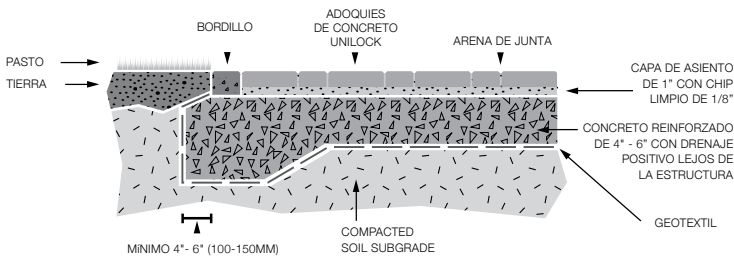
Instalación de pavimentos de adoquines sobre concreto fundido en el sitio
